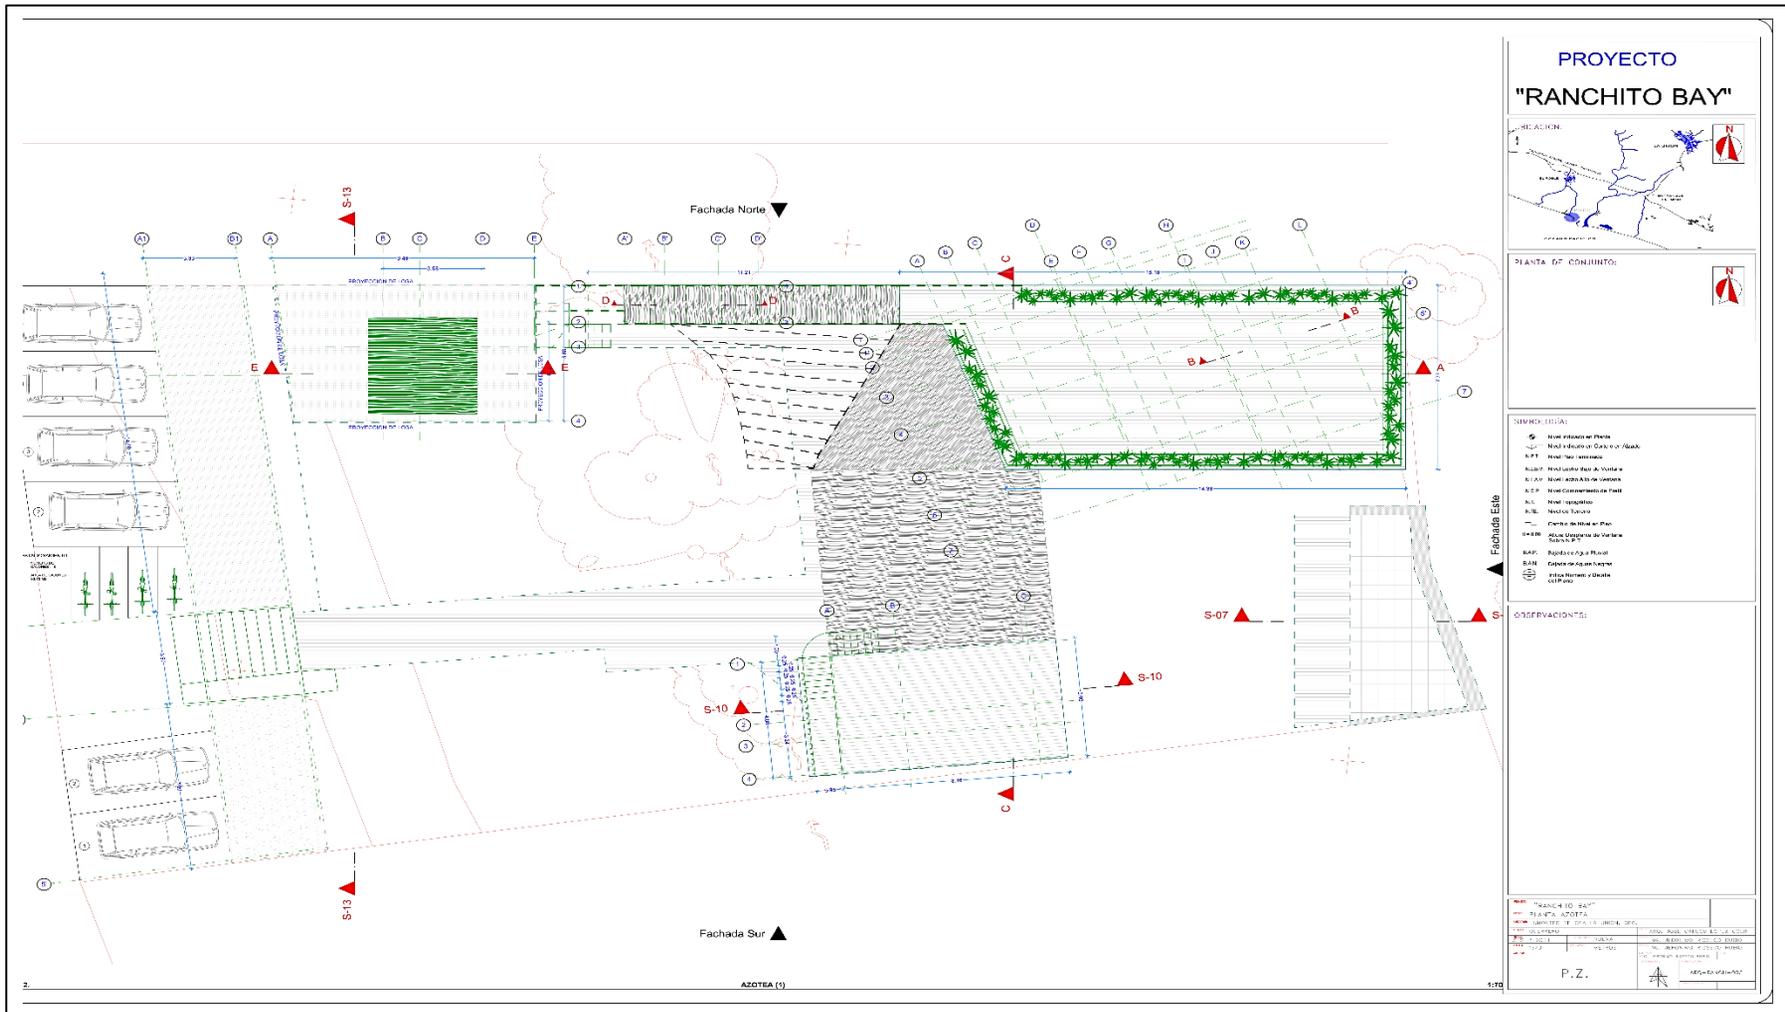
Plano de conjunto de la planta azotea del proyecto.
